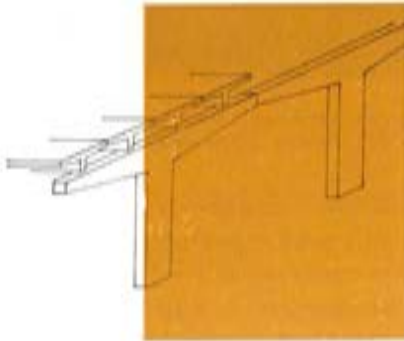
Anchorage: Esquema de la estructura del Alaska Sales and Service.
